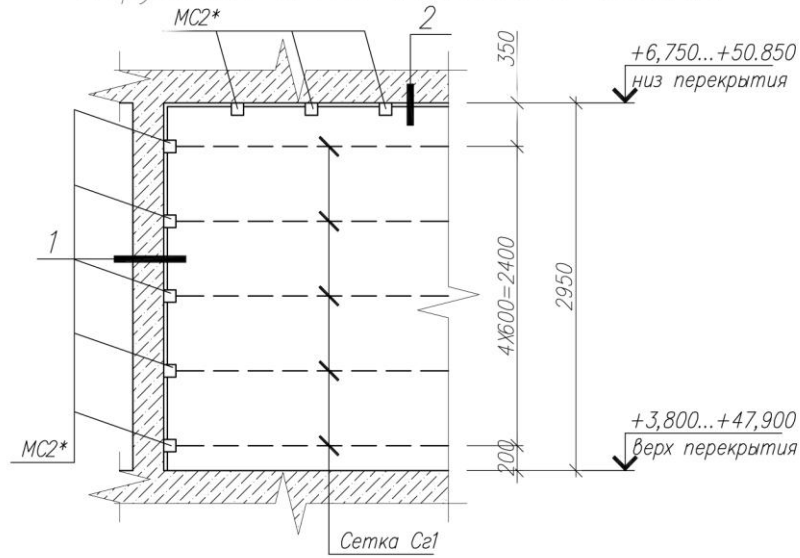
Схема узла крепления наружных стен типового этажа из керамзитобетонных блоков
